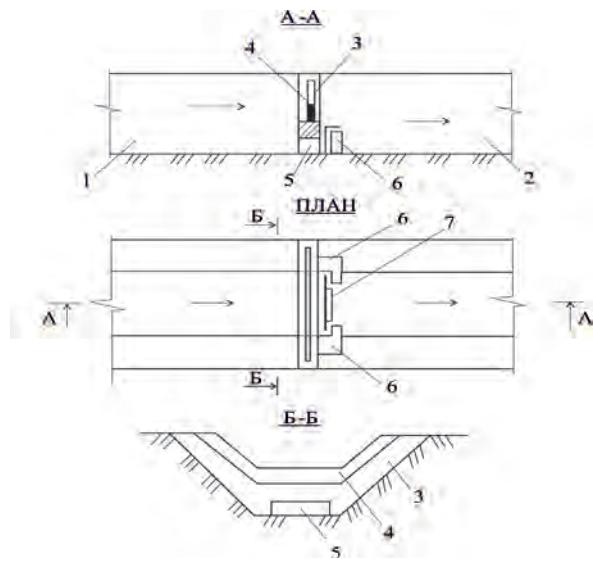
Схема водомерного сооружения со щитом: 1, 2 – подводящий и отводящие участки; 3 – диафрагма; 4 – водослив с тонкой стенкой; 5 – наносопромывное отверстие; 6 – береговые упоры; 7 – запорное устройство
